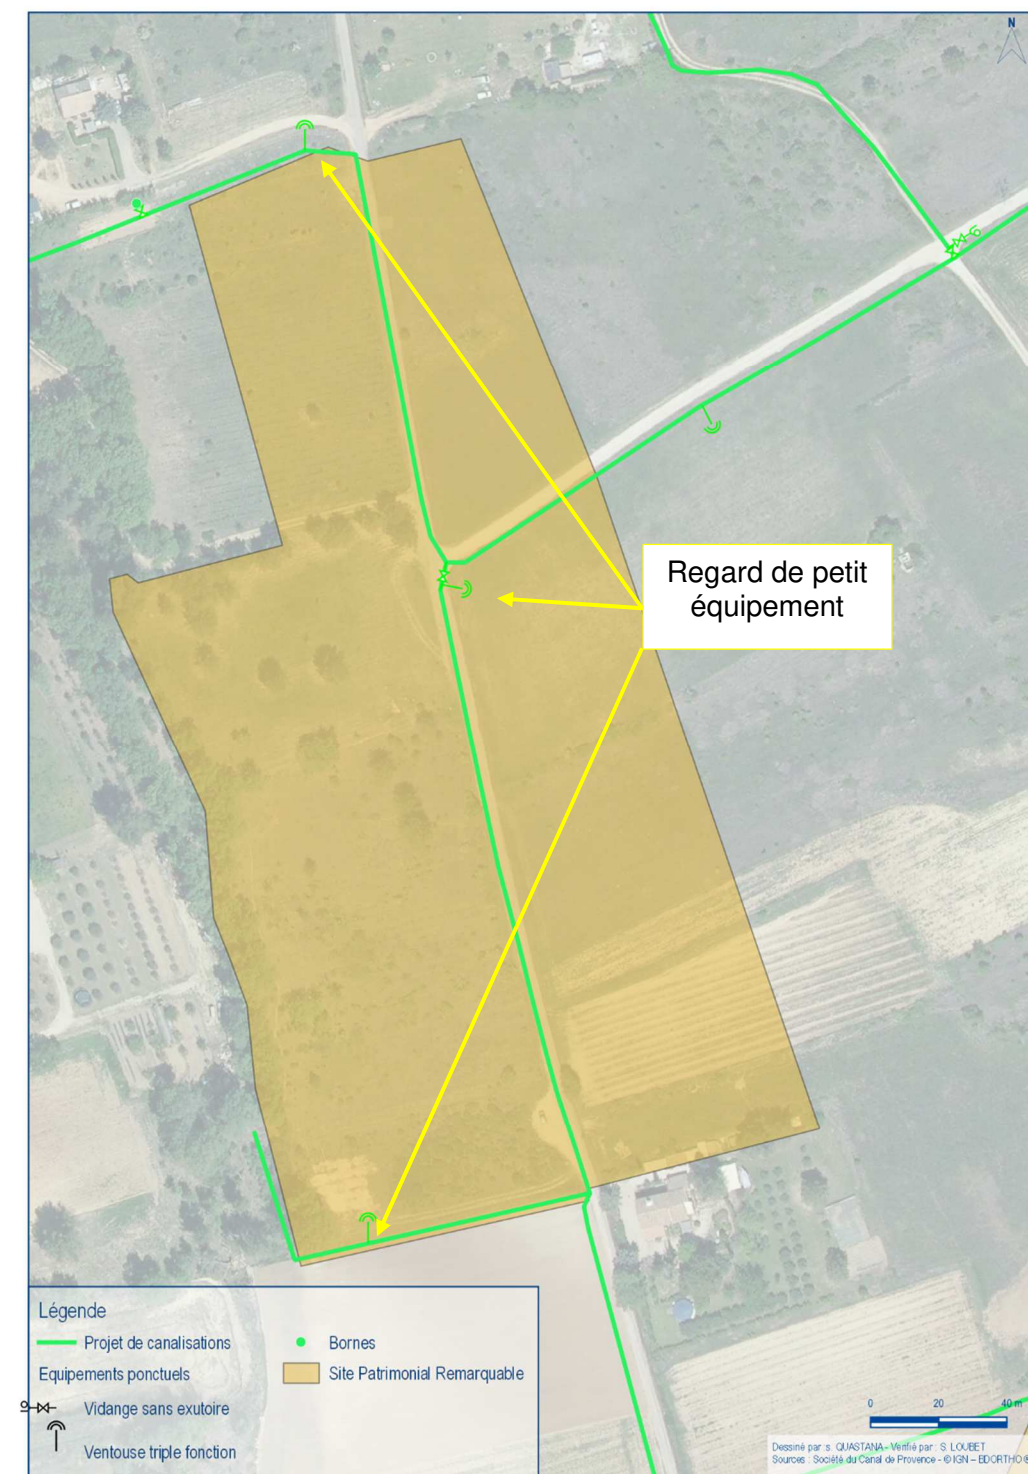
Zoom secteur sud 1 sur fond photo aérienne (source : Orthophoto)
